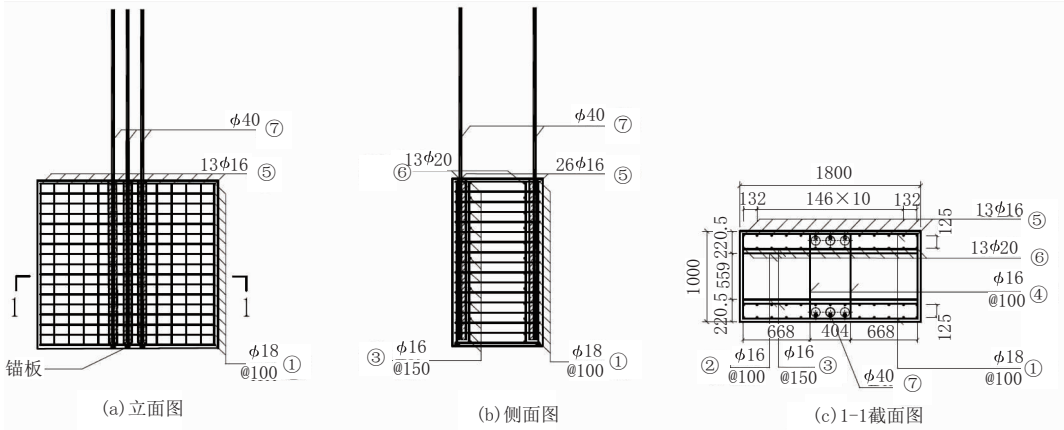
灌浆波纹钢管拉拔试件钢筋示意图(单位:mm)
